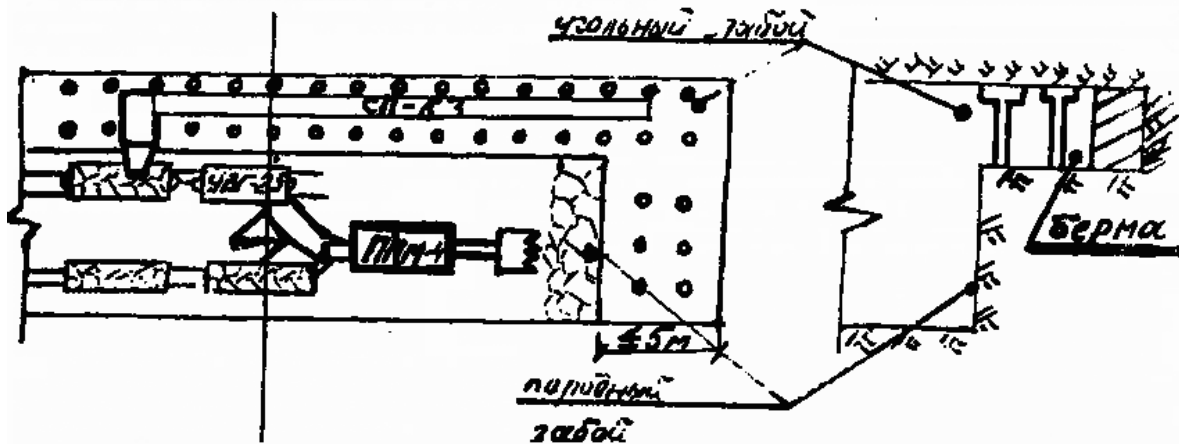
Технологическая схема проведения штреков узким забоем с нижней подрывкой и раздельной выемкой угля и породы при совмещении этих работ во времени
